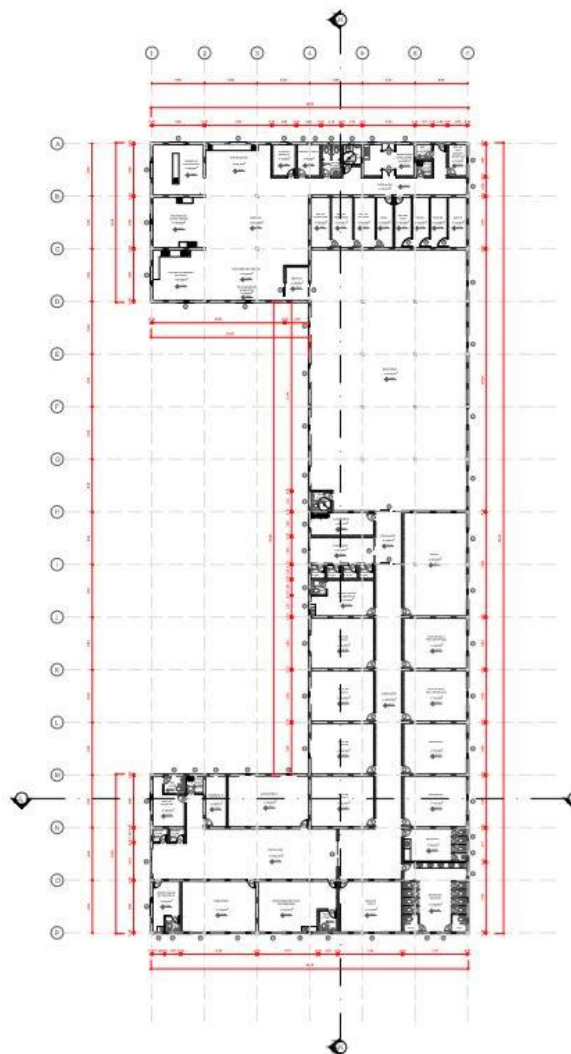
Planta Técnica – Fonte: Acervo Próprio
